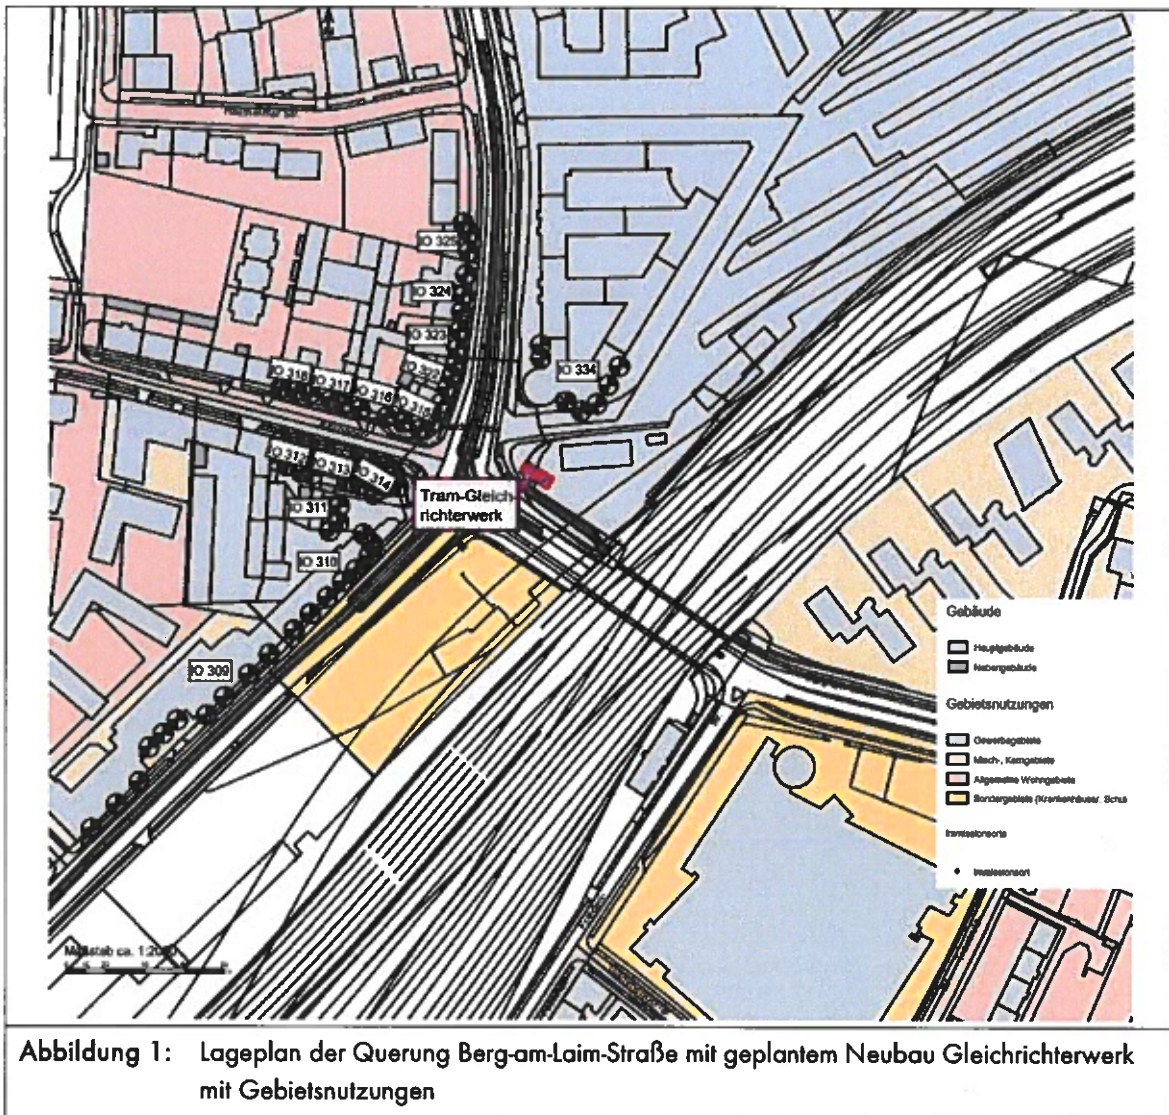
Lageplan der Querung Berg-am-Laim-Straße mit geplantem Neubau Gleichrichterwerk mit Gebietsnutzungen
